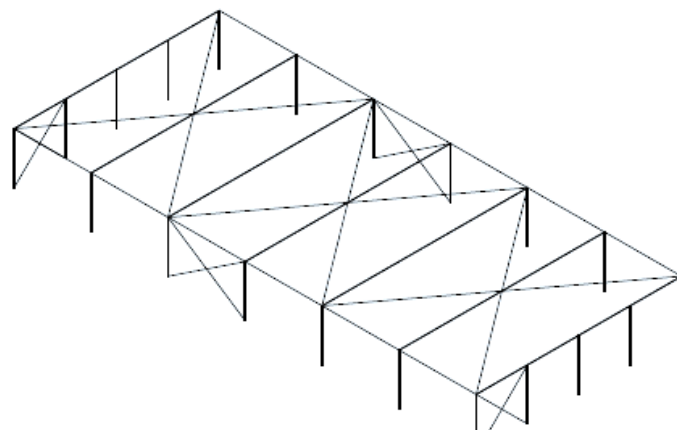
Pórtico de vigas simplesmente apoiadas [13]
